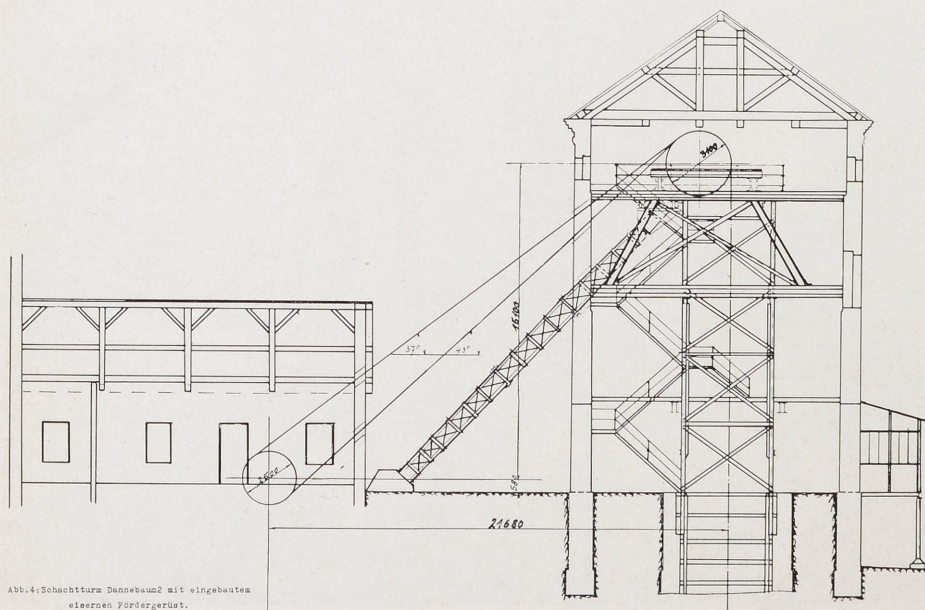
Schachturm Dannebaum 2 mit eingebautem eisernen Fördergerüst.
